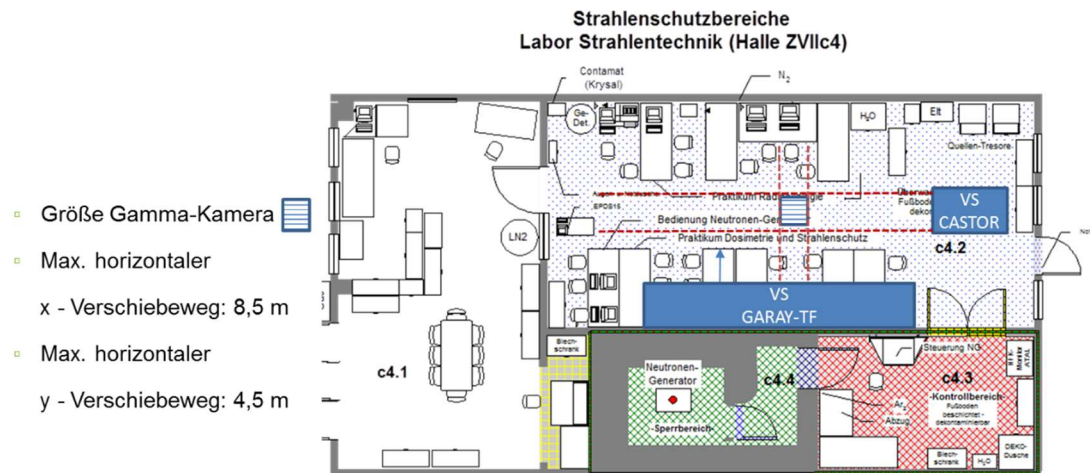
Grundriss des Strahlenlabors der HSZG und freie Verschiebewege für Gamma-Kamera
